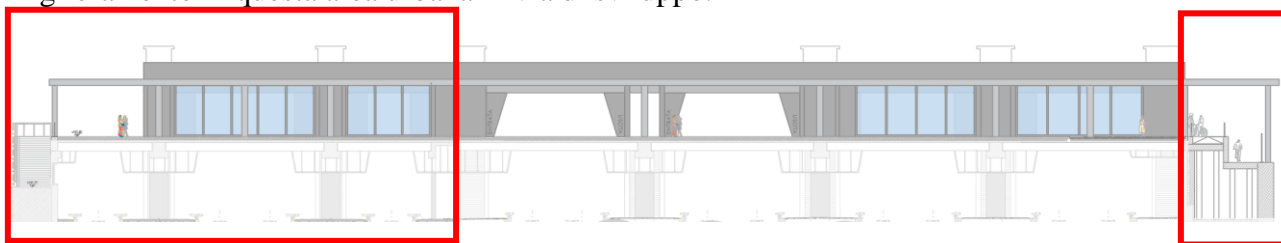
Prospetto sud con indicazione dell’ampliamento.
